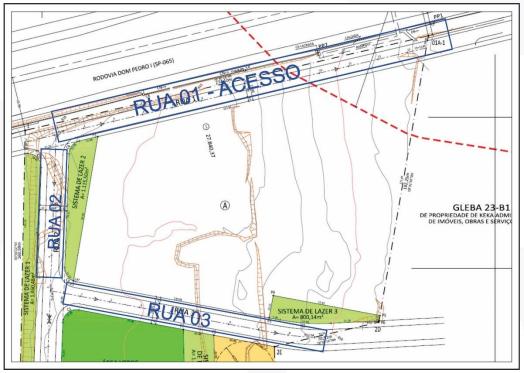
Implantação das vias – Ruas 01, 02 e 03 Fonte: Projeto Urbanístico do loteamento.
